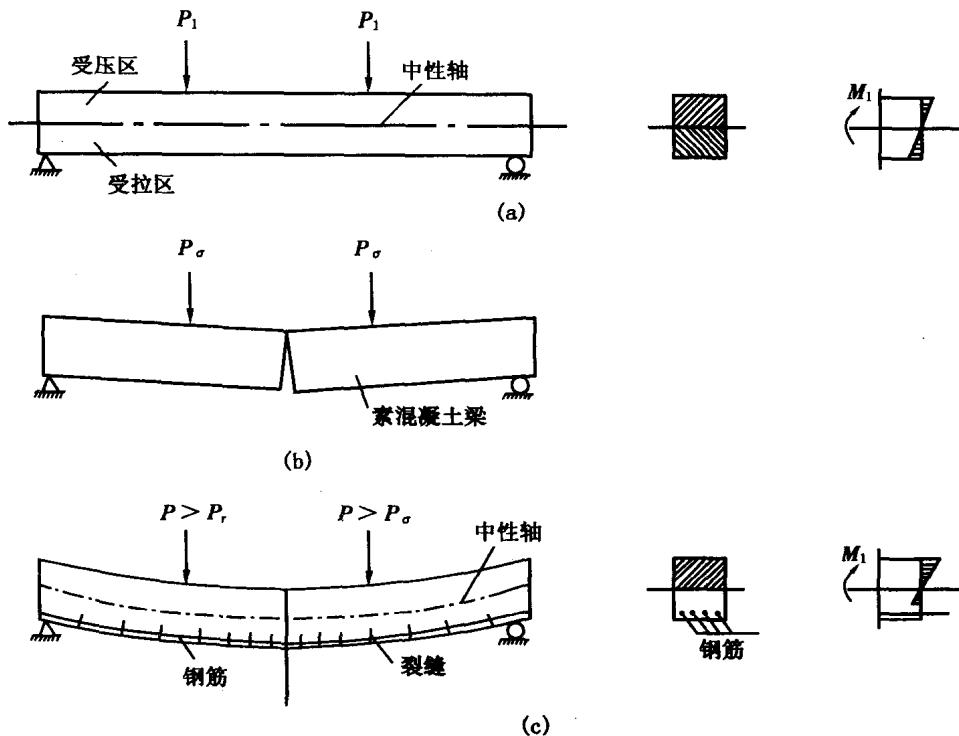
素混凝土梁和钢筋混凝土梁的受力破坏情况
